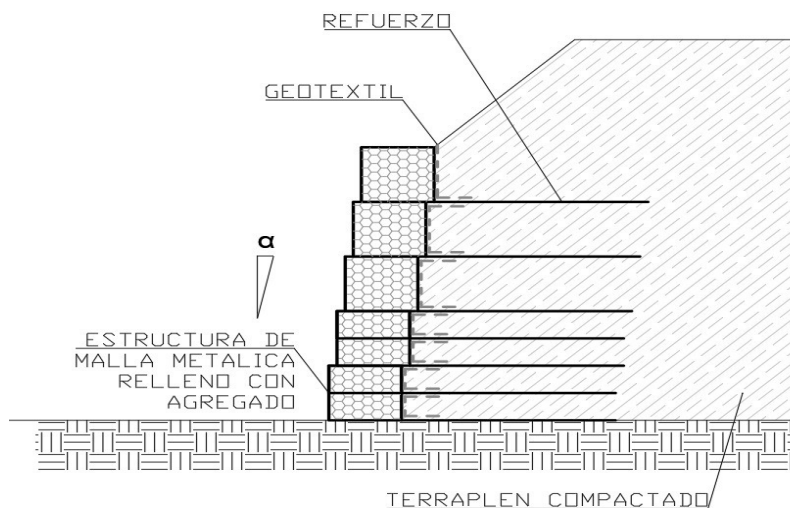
Sistema muro reforzado con paramento frontal de malla metálica tejida
